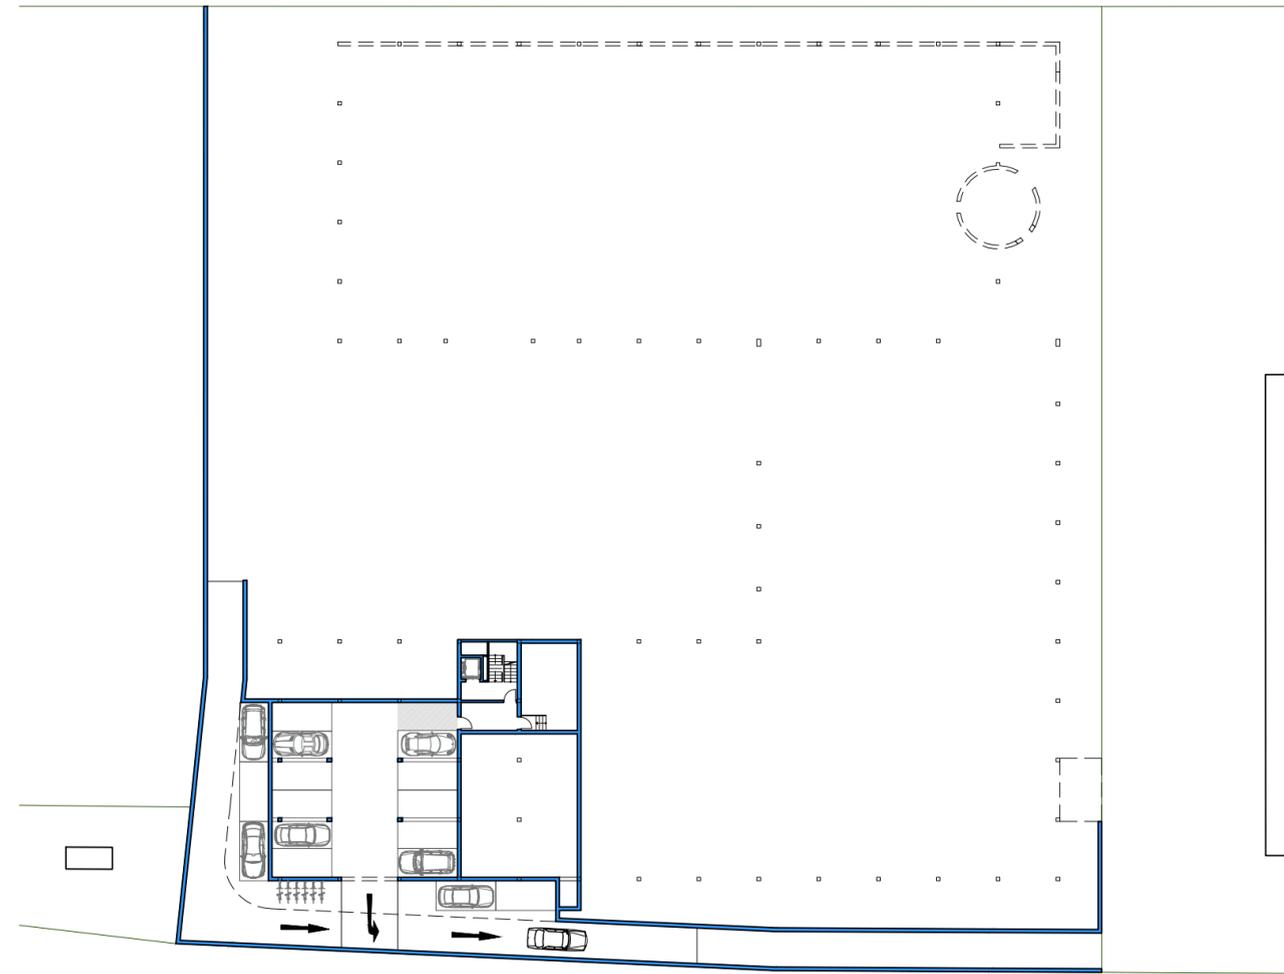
Vorentwurf III - Grundriss Kellergeschoß
